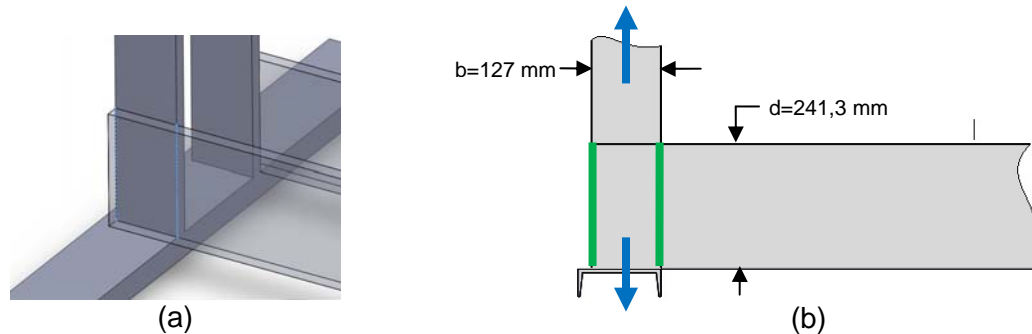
Juntas soldadas sob tração: arestas de solda (a) e vista frontal (b).
